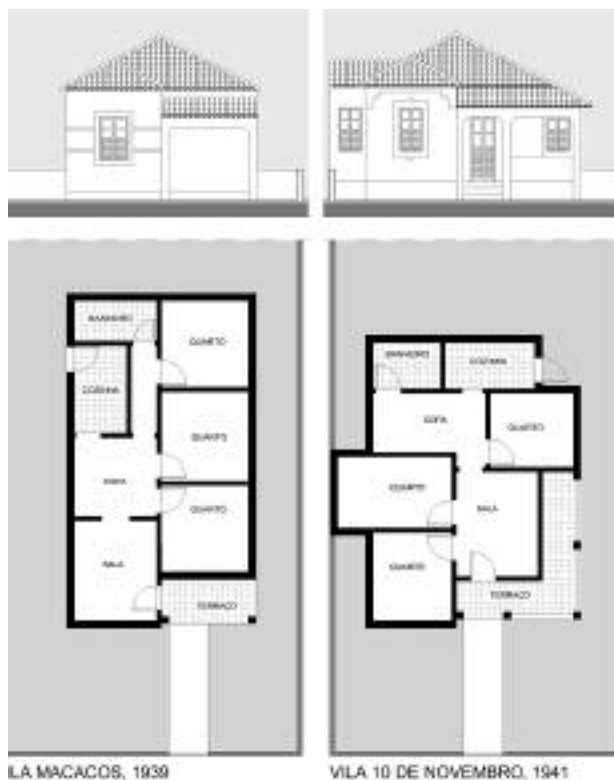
Planta e fachada frontal original da unidade construída na Vila Macacos e Vila 10 de Novembro.
